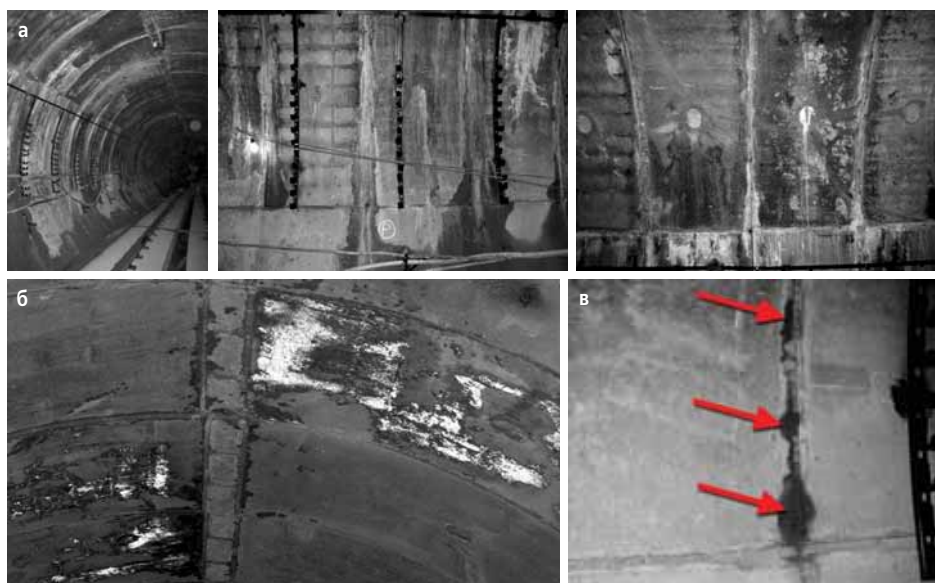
Водопроявления в тоннеле из-за усадки бетона (2009 г.): а – через трещины в бетоне блоков и стыки; б – из-за фильтрации воды через бетон; в – из-за усадки бетона блока и раствора шва стыков обделки
